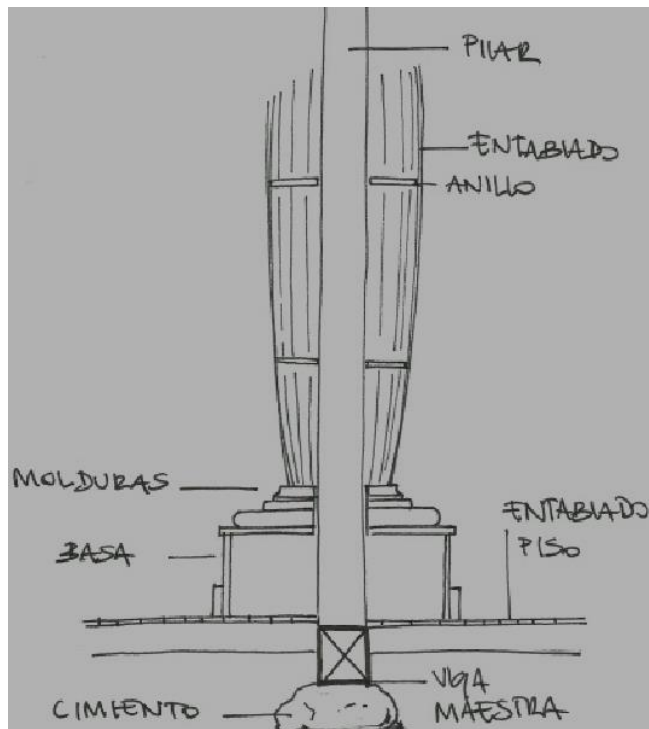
Iglesia de Chonchi, croquis sección apoyo estructura
